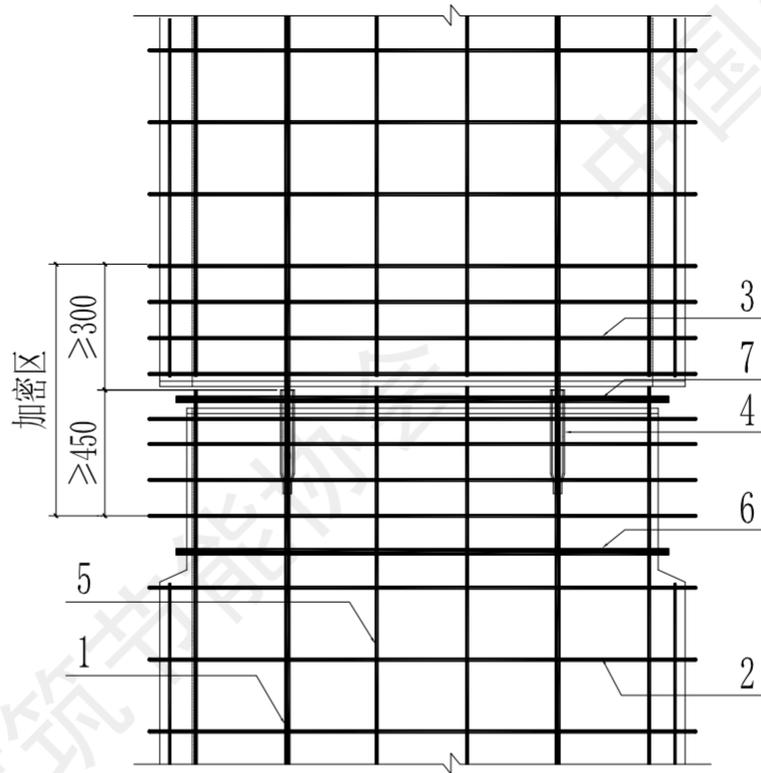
钢筋套筒灌浆连接部位的水平分布钢筋加密构造
